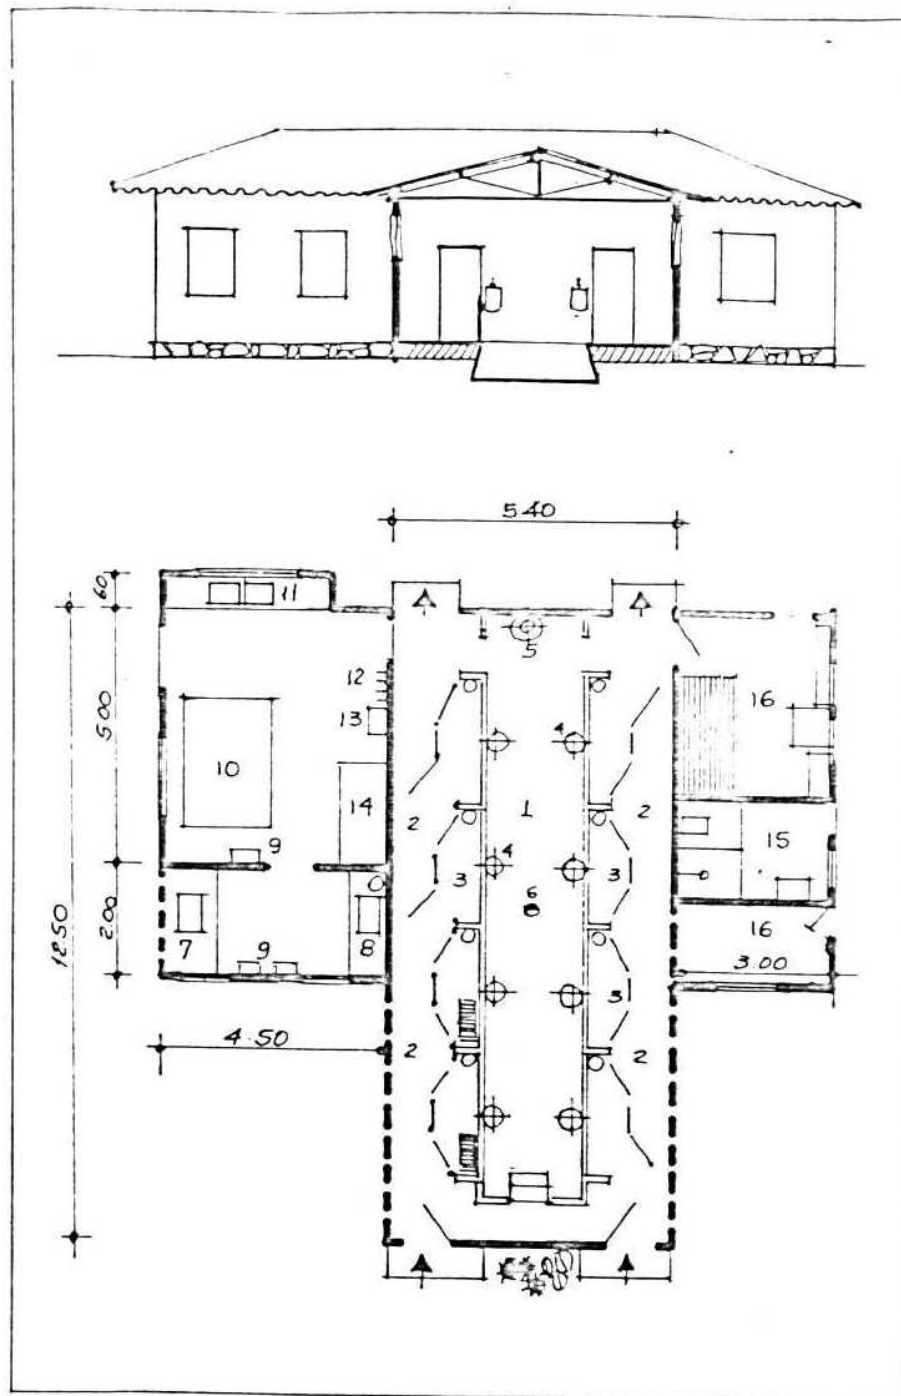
Corte vertical transversal e planta baixa de estábulo com sala de leite modelo (M-11) (Sala de ordenha Tandem).
